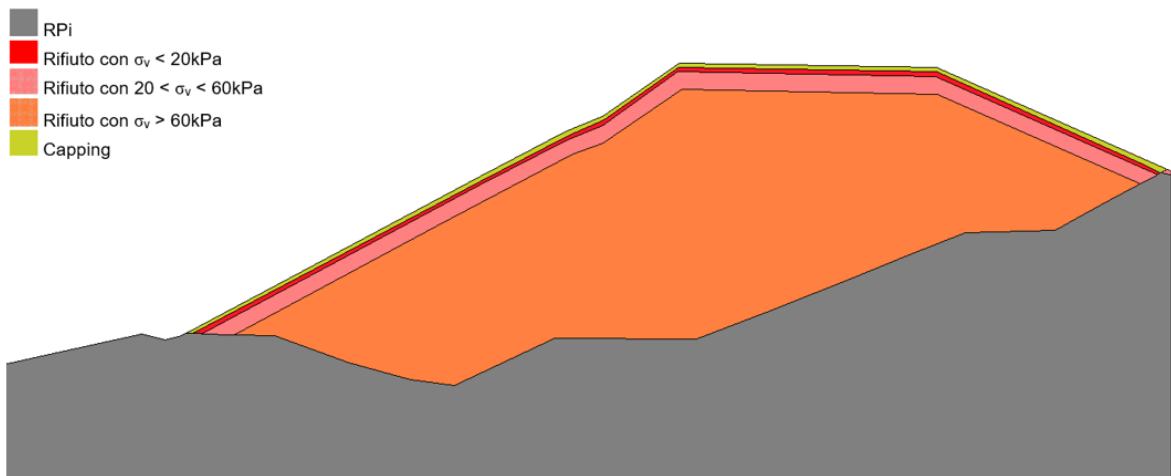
Sezione laterale (Sezione 11) – Configurazione finale
